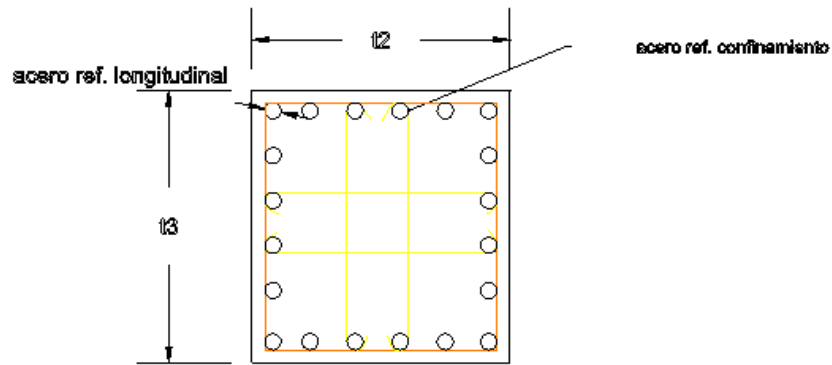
Ilustración de la sección rectangular para el modelamiento de columnas
